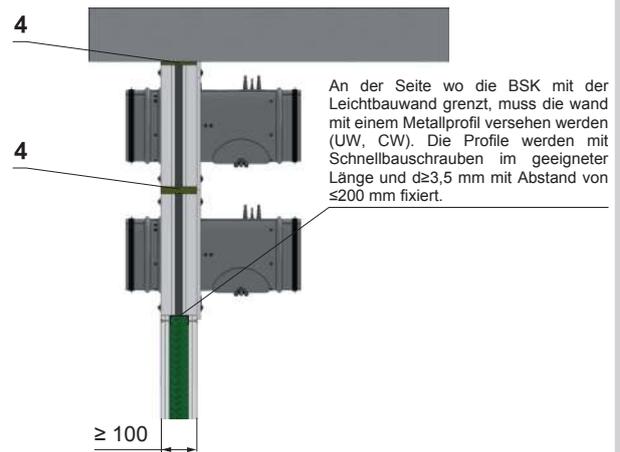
Leichtbauwände - Nasseinbau - Wand- und Deckenanschluss - Gips oder Mörtel und Mineralwolle
